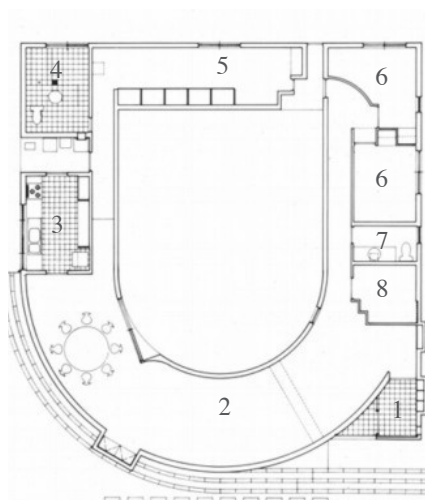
| White U House, Planta; 1- entrada, 2- hall, 3- cozinha, 4- casa de banho, 5- escritório, 6 - quarto, 7- sanitário, 8- closet
